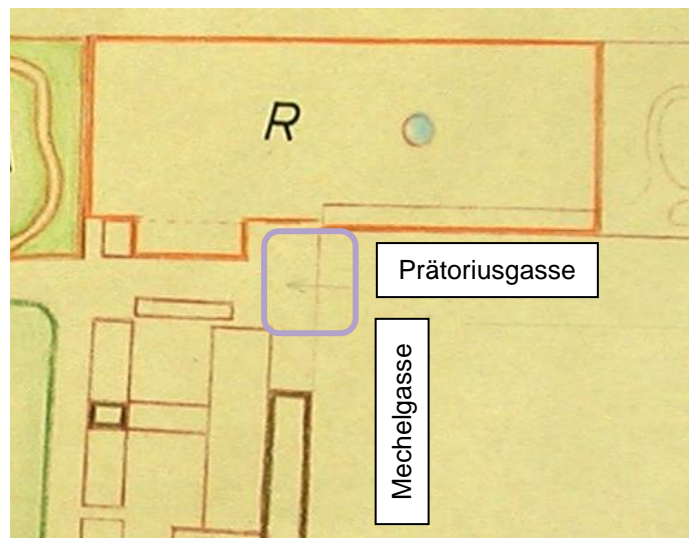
Detaillauschnitt aus dem Lageplan 1970; Markierung des zur Mechelgasse verlegten Haupteinganges (lila).
